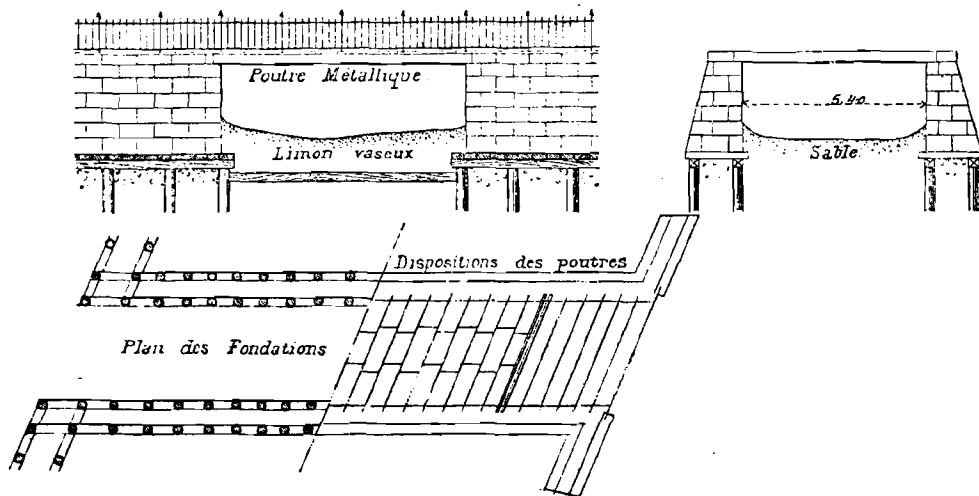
, 6 et 7. — Plan, coupe longitudinale et coupe transversale d'un pont construit sur pilotis.
